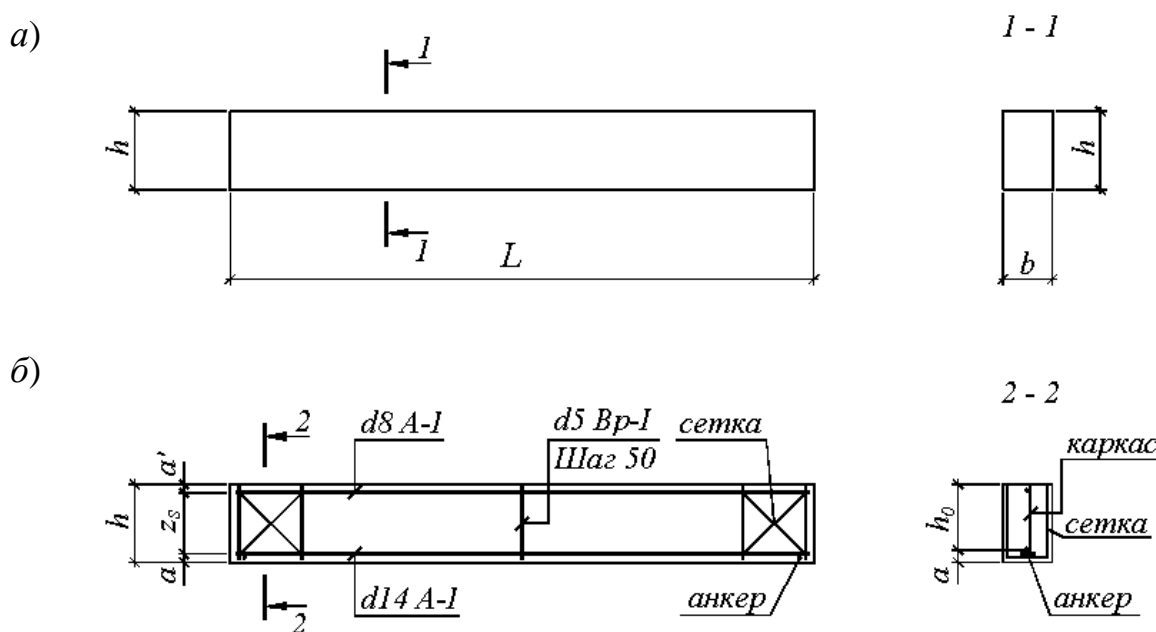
Опалубочные размеры (а) и армирование опытной балки (б)
